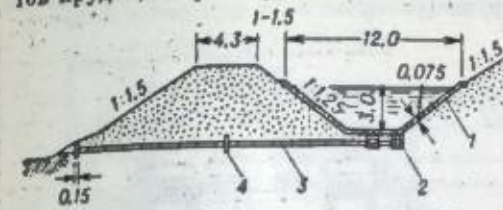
Дренаж облицовки: 1 — железобетонная облицовка; 2 — продольные дренажи; 3 — поперечный коллектор (гончарные трубы через 60—240 м); 4 — железобетонная диафрагма.
